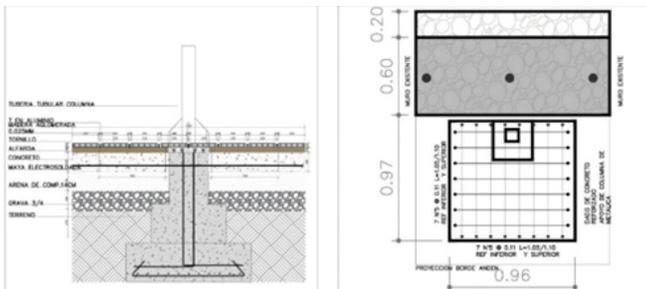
Planta y detalle de zapata y dado de concreto reforzado
